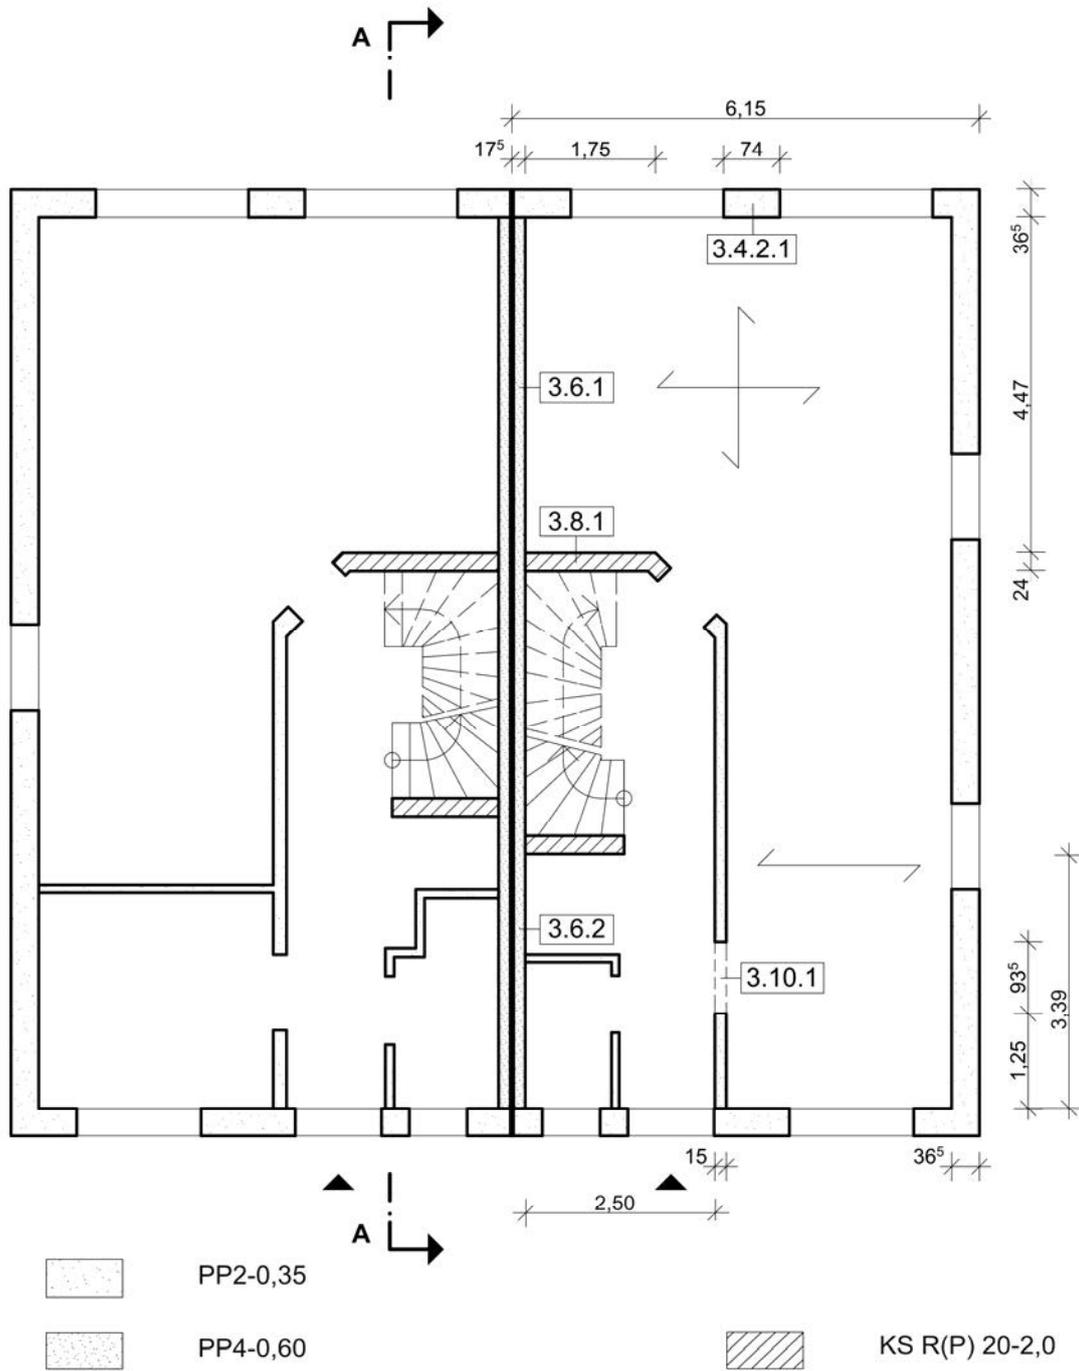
Doppelhaus in Hövelhof, Grundriss Erdgeschoss
